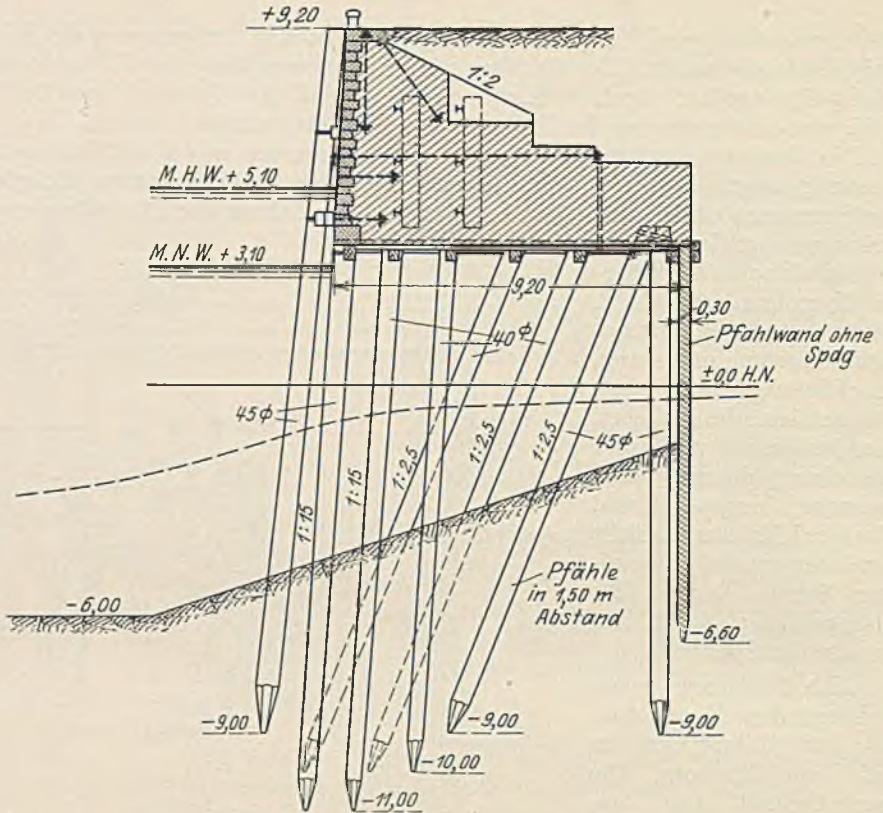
Hamburger Ufermauer auf hochliegendem Holzpfahlrost.
